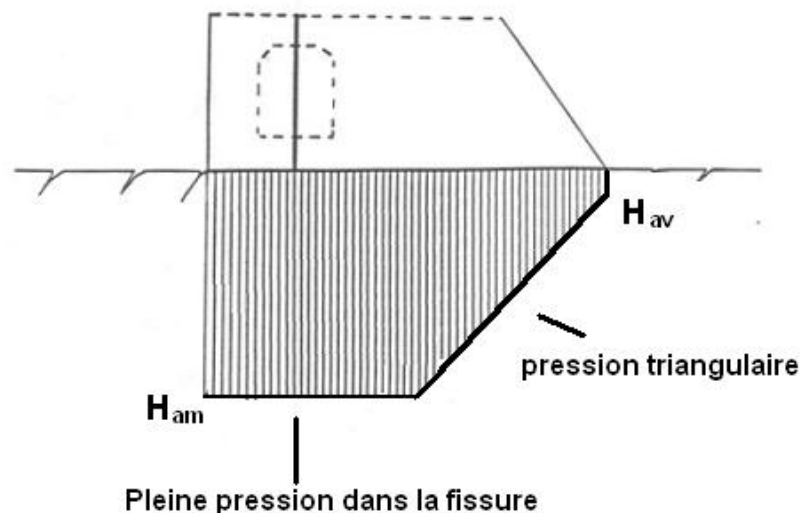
7 - Sous pressions si la fissuration dépasse le rideau de drainage
